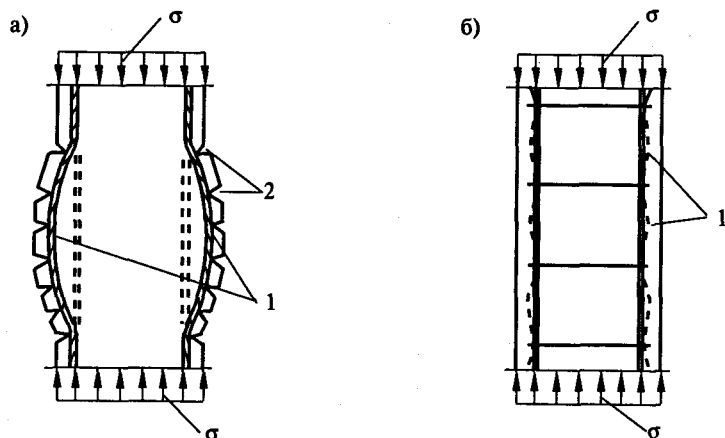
Потеря устойчивости арматуры в сжатом железобетонном элементе: а) при отсутствии поперечной арматуры; б) при наличии поперечной арматуры (хомуты); 1 — выпучивание продольной арматуры; 2 — разрушение бетона
